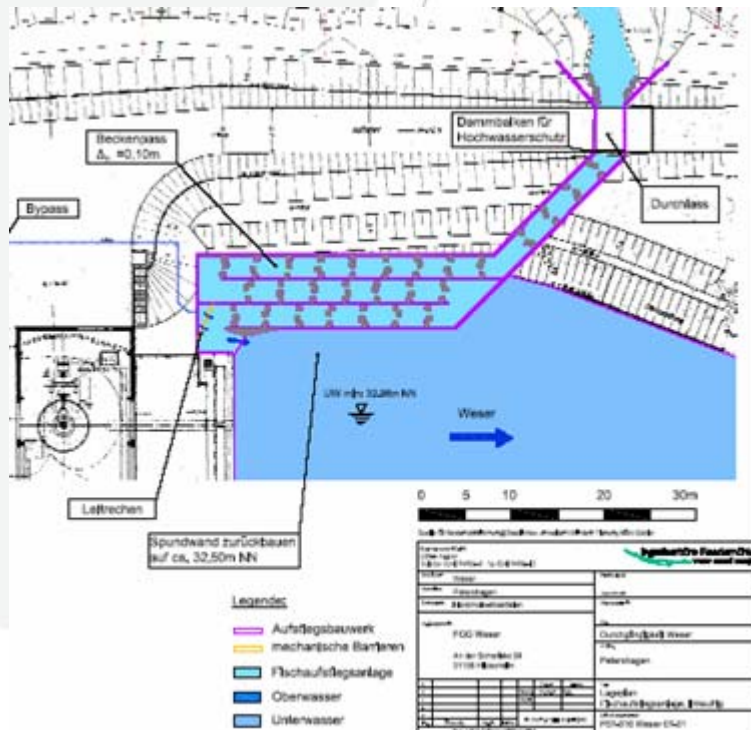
Lageplan Standort Petershagen. Quelle: E.ON
